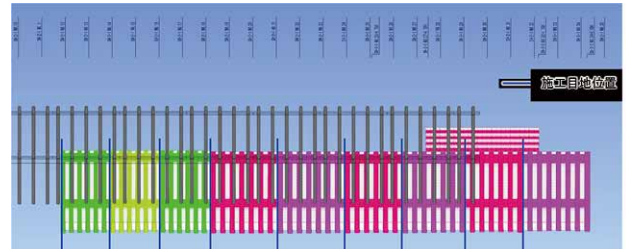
CDM施工モデルとクレーンレール基礎杭の鳥瞰図
